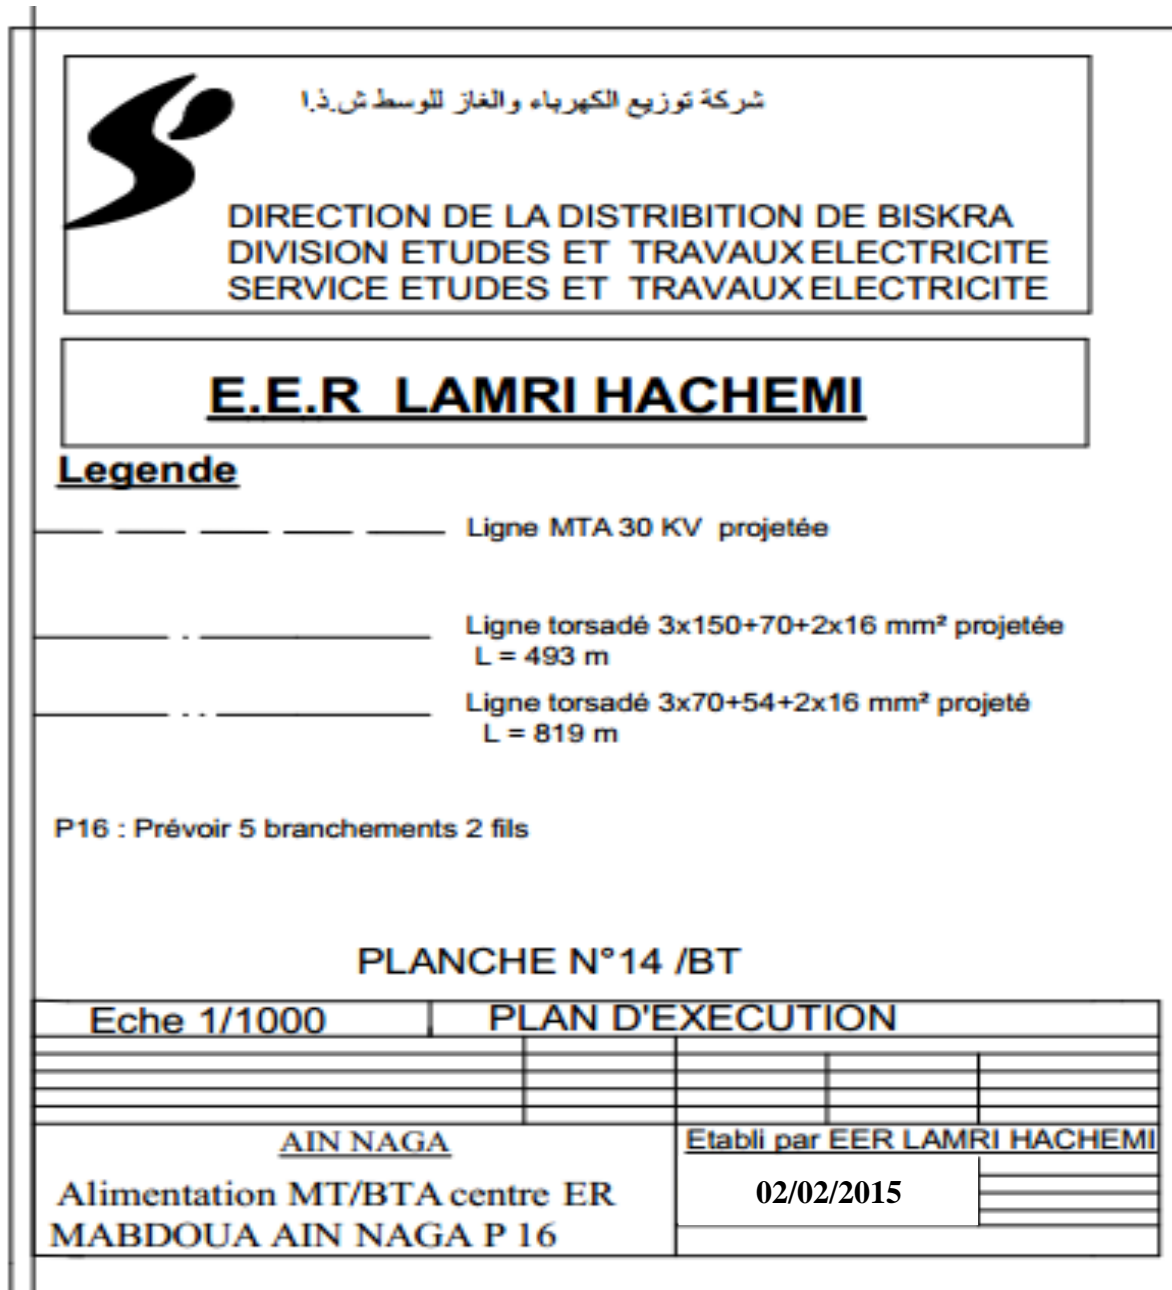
PLAN D'EXECUTION D'UN RESEAUX BT
